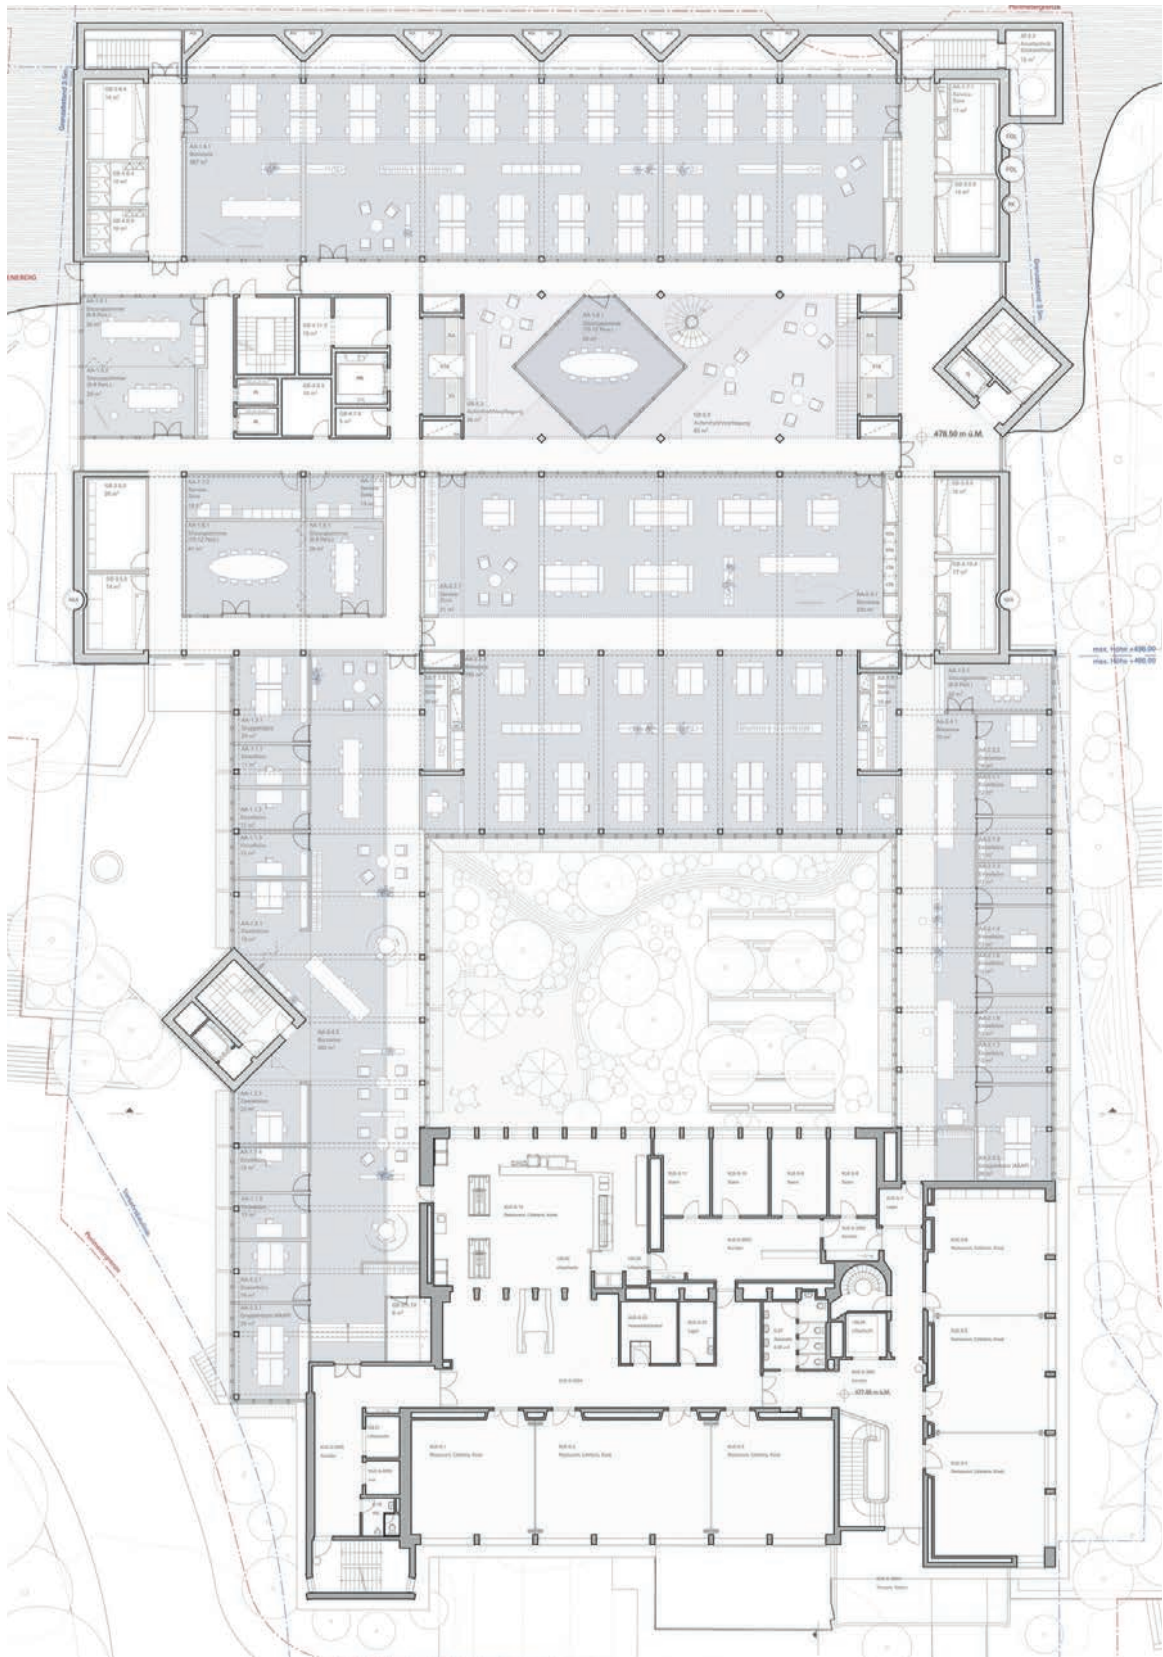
Boltshauer Architekten mit Mettler Landschaftsarchitekten: Grundriss 1. Obergeschoss
